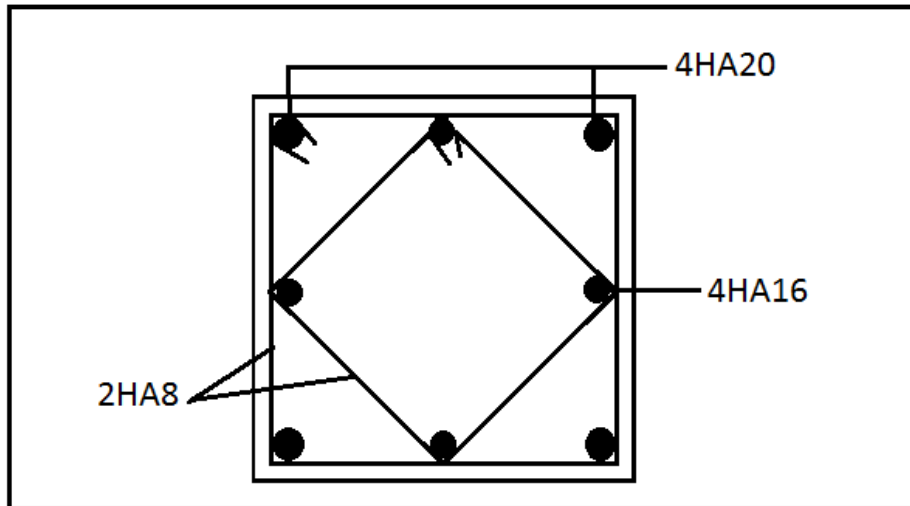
Ferrailage Poteau 45x45
